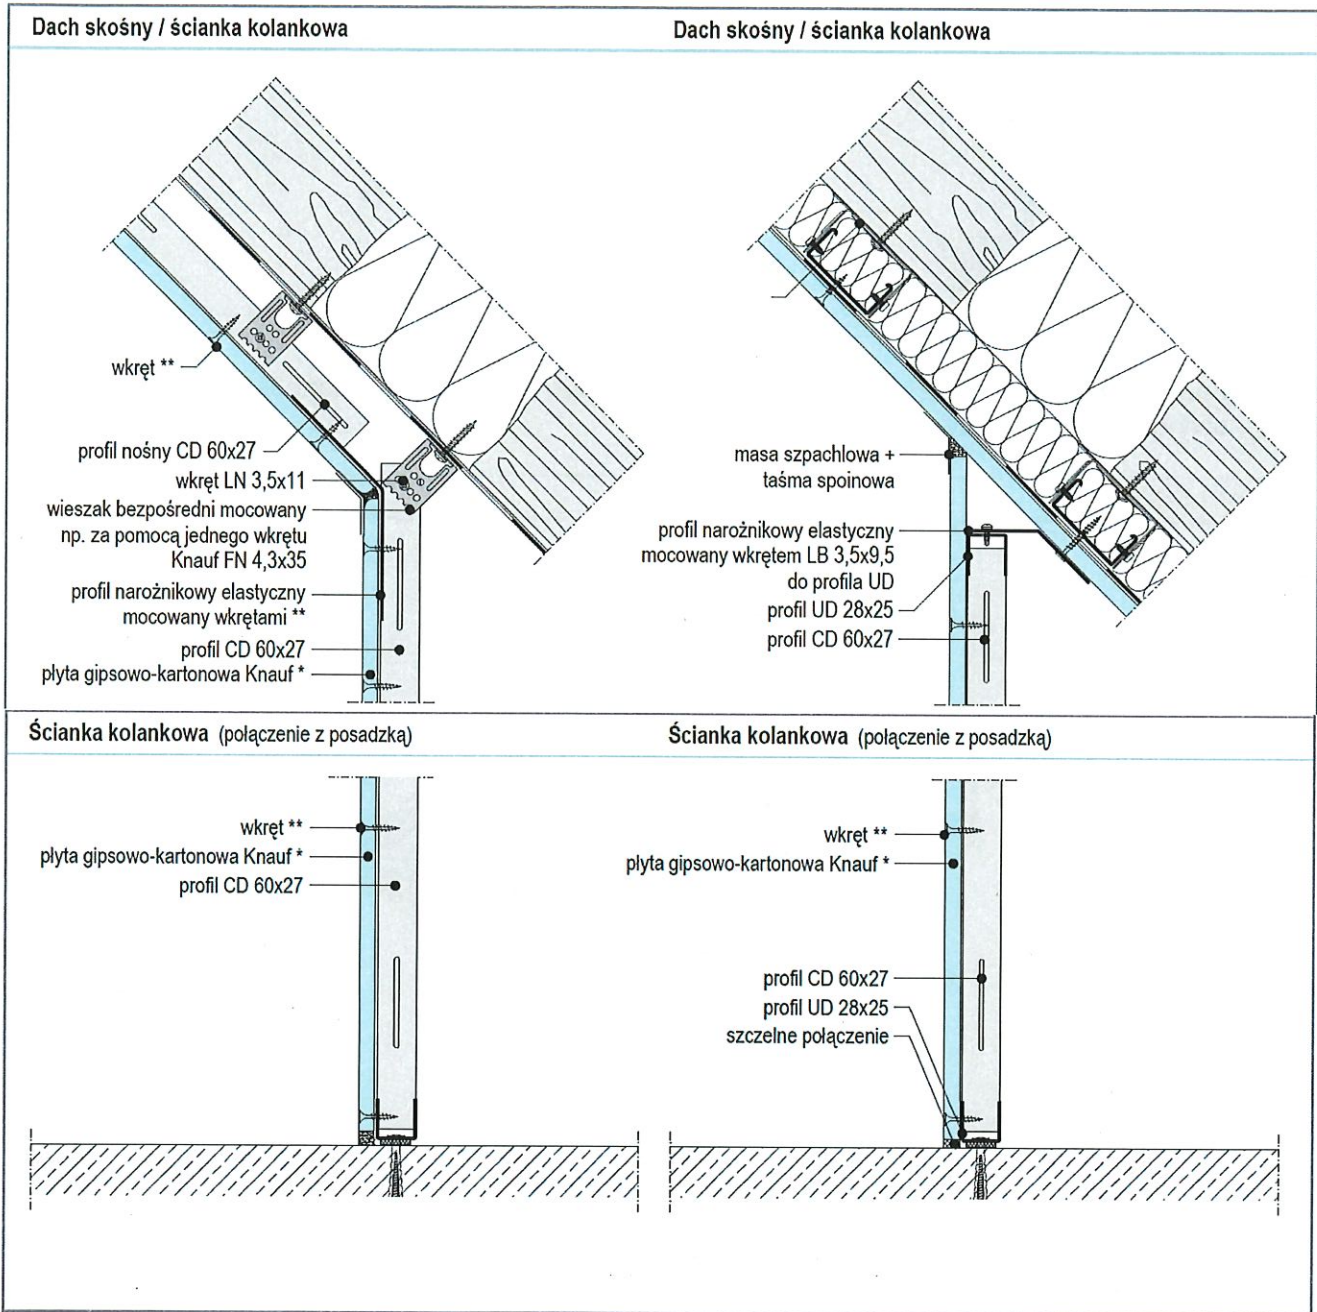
System D612.pl na pojedynczej konstrukcji z wieszakiem bezpośrednim, przekrój pionowy dachu spadzistego.
